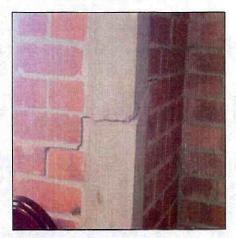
Grietas diagonales en el muro del patio de la casa ubicada en la Cra. 72 # 68A-34 Sur
